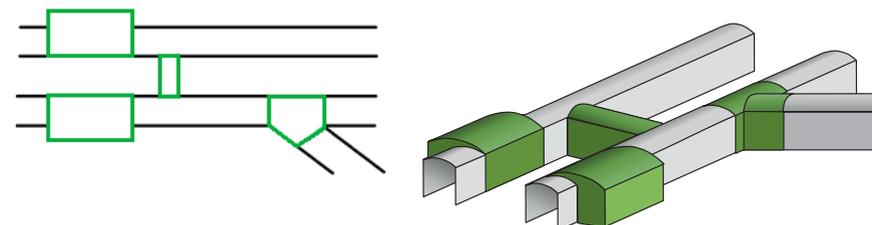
Cenários de seções de túnel para revestimento em concreto projetado livre de formas
